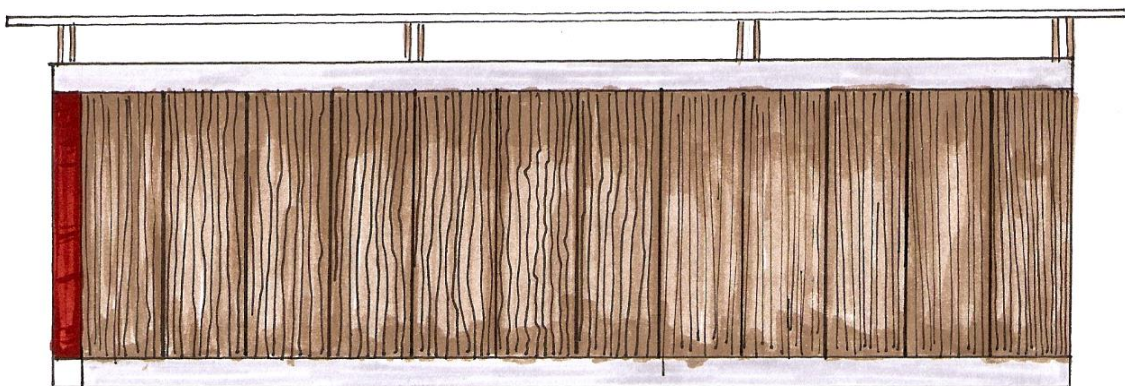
Fachada das residências dos trabalhadores locais. (Sem Escala)
